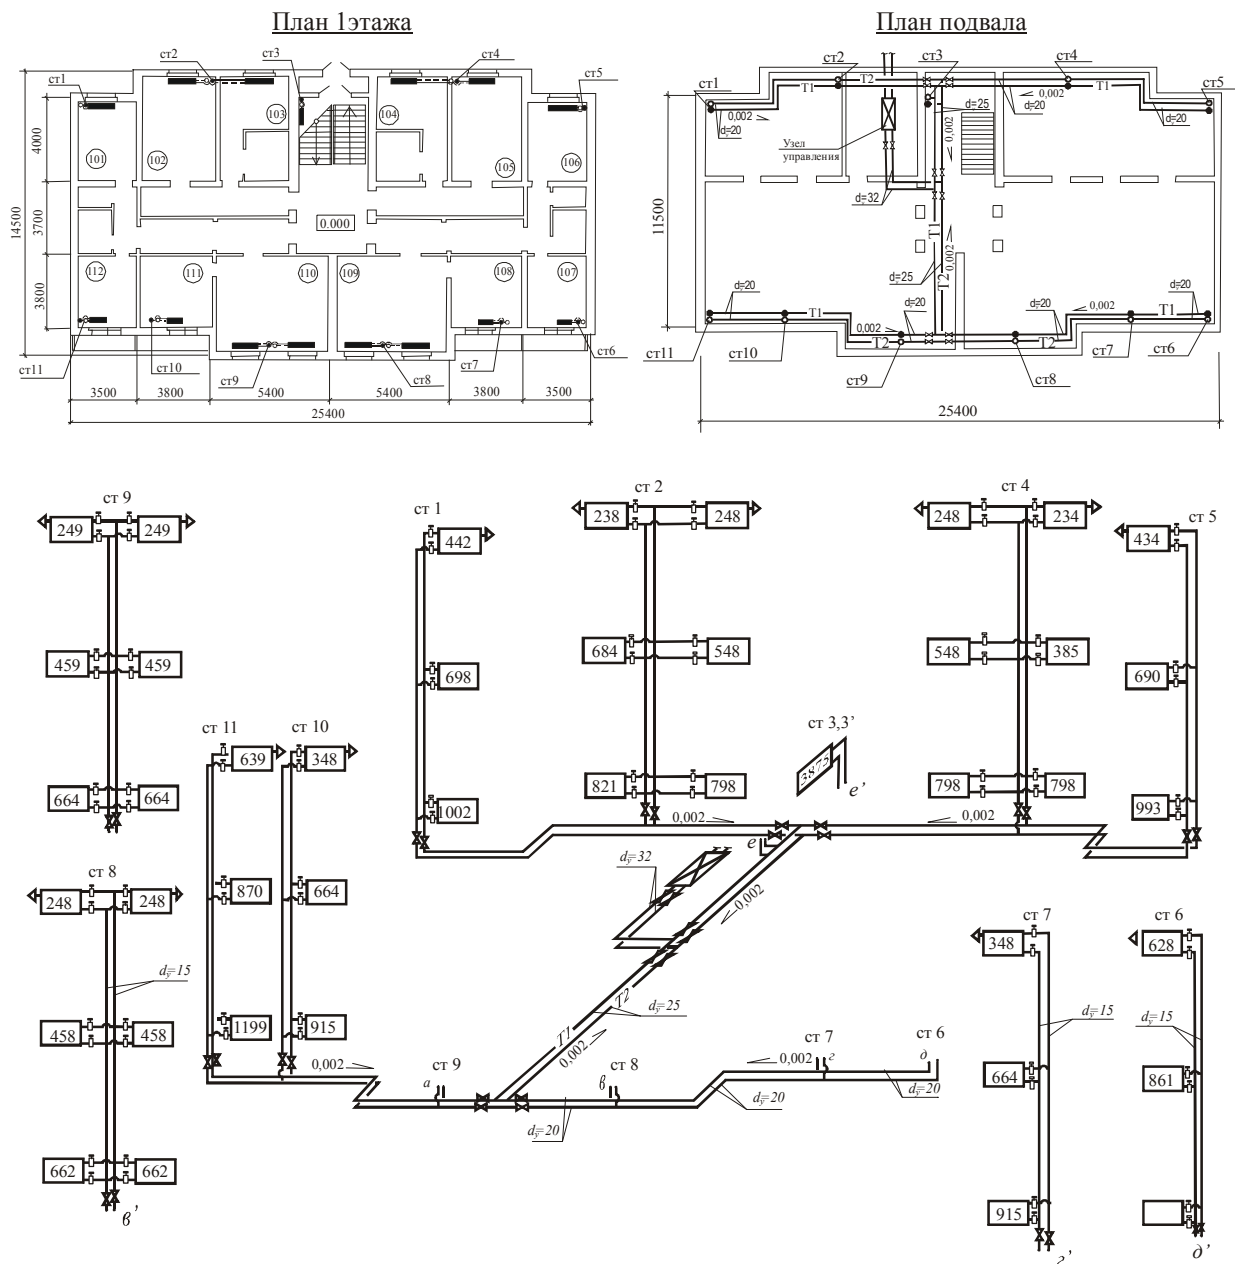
Конструкция двухтрубной системы отопления с нижней разводкой
